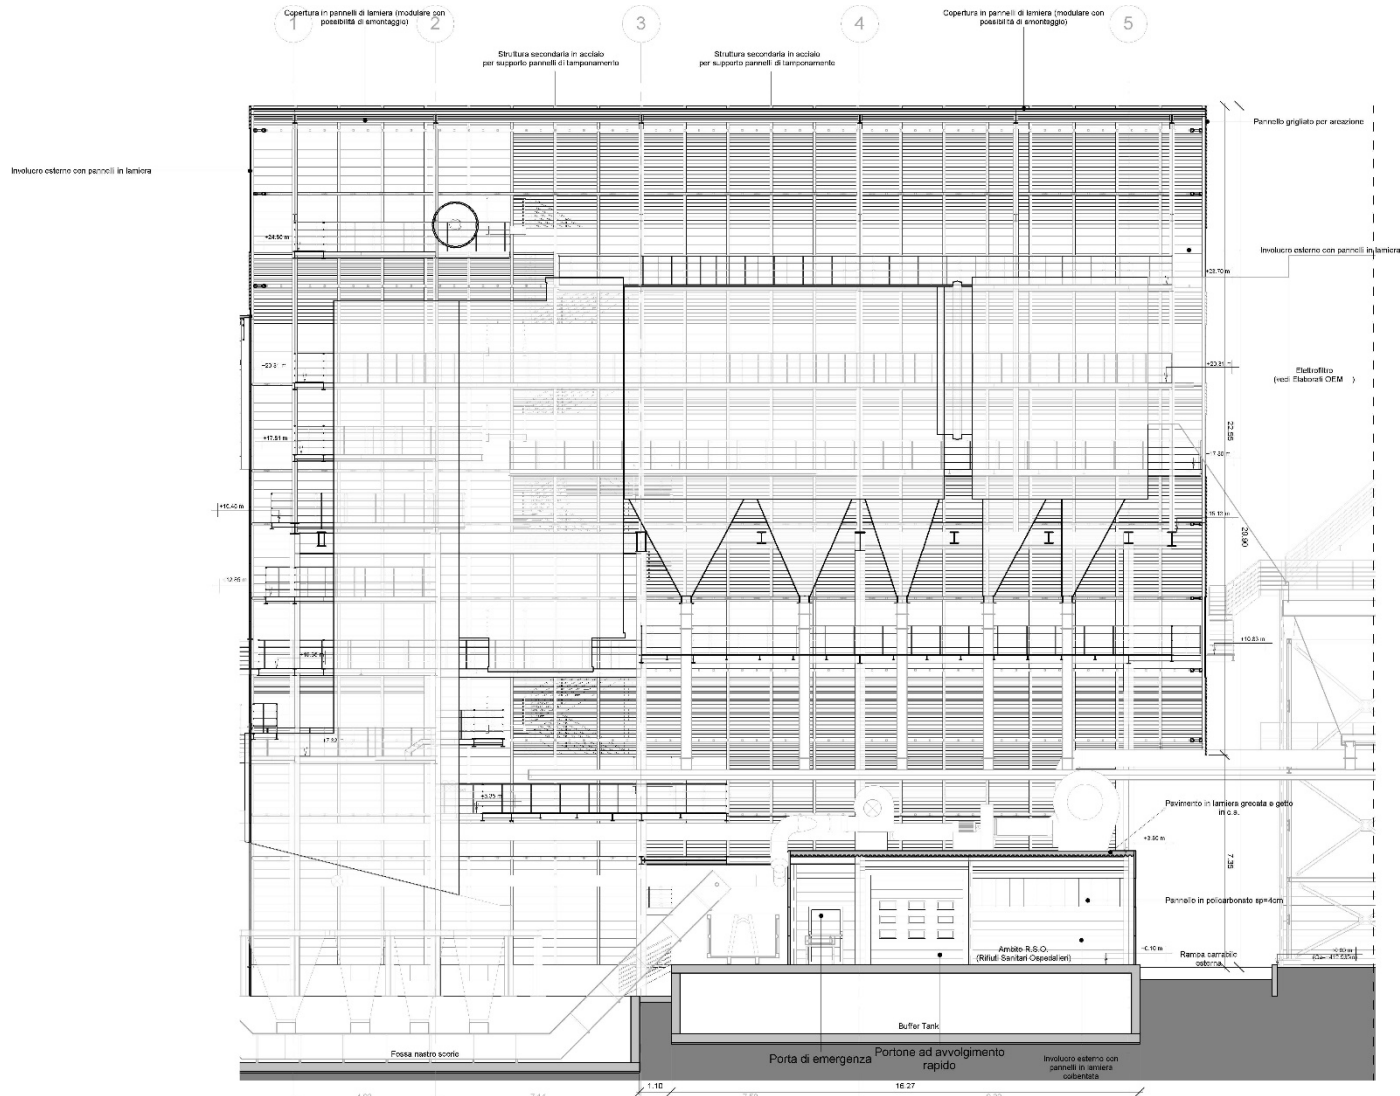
Sezione longitudinale L-L Edificio Caldaia
